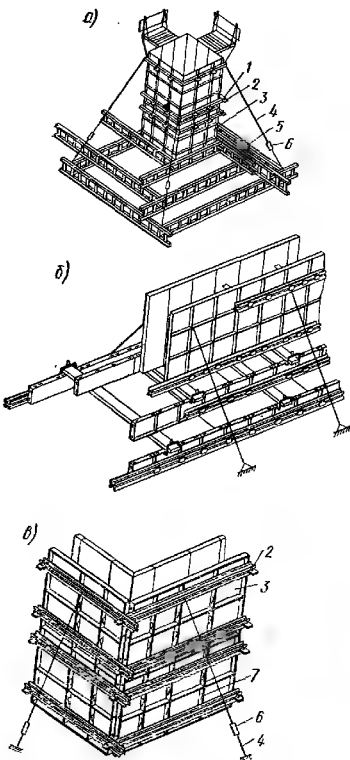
Общий вид смонтированной опалубки: а — ступенчатого фундамента; б — ленточного фундамента; в — угла стен; 1 — клин для крепления схватки; 2 — угловое соединение схватки; 3 — щит опалубки; 4 — расчалка; 5 — ферма; 6 — фанкер; 7 — пружинная скоба
